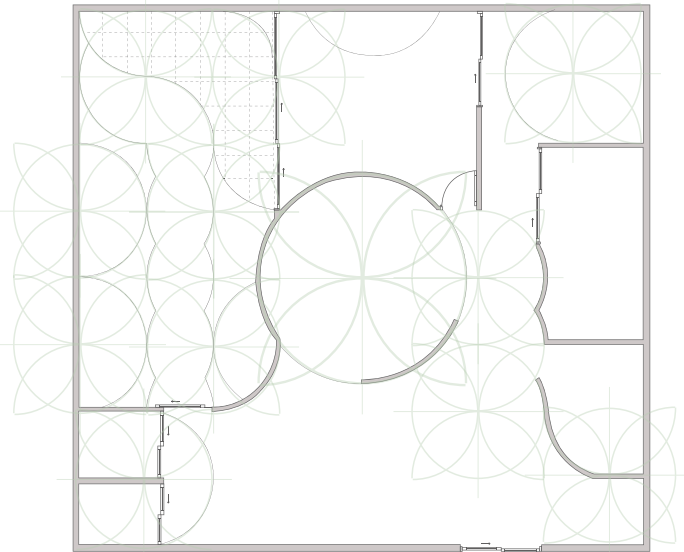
Aplicación de token en planta. Elaboración Sharon Chavez.
